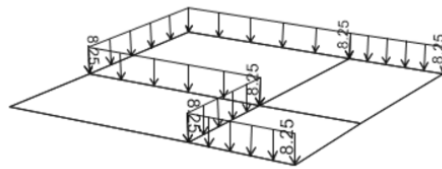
Peso das Paredes nas Vigas de Fundação
